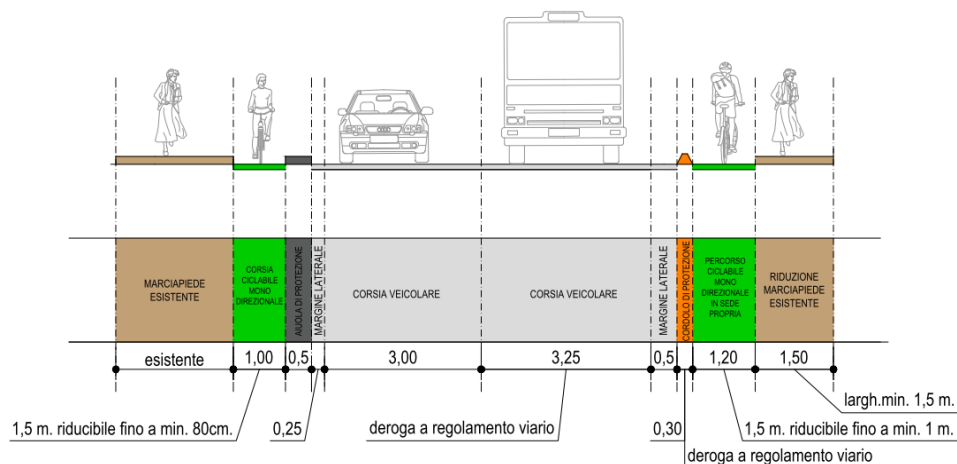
Sezione di via Sanvito Silvestro nel tratto tra via Nicotera e via della Brunella
